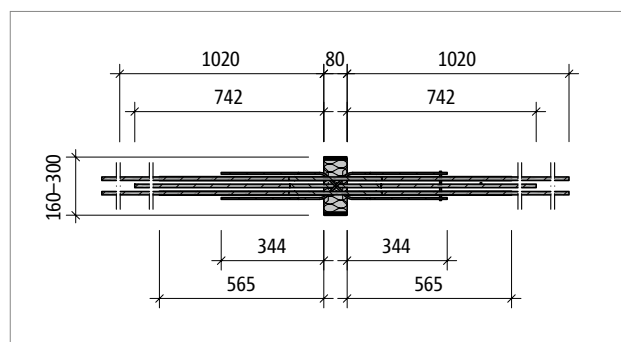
Schöck Isokorb® T type W-M4 : plan de base du produit
